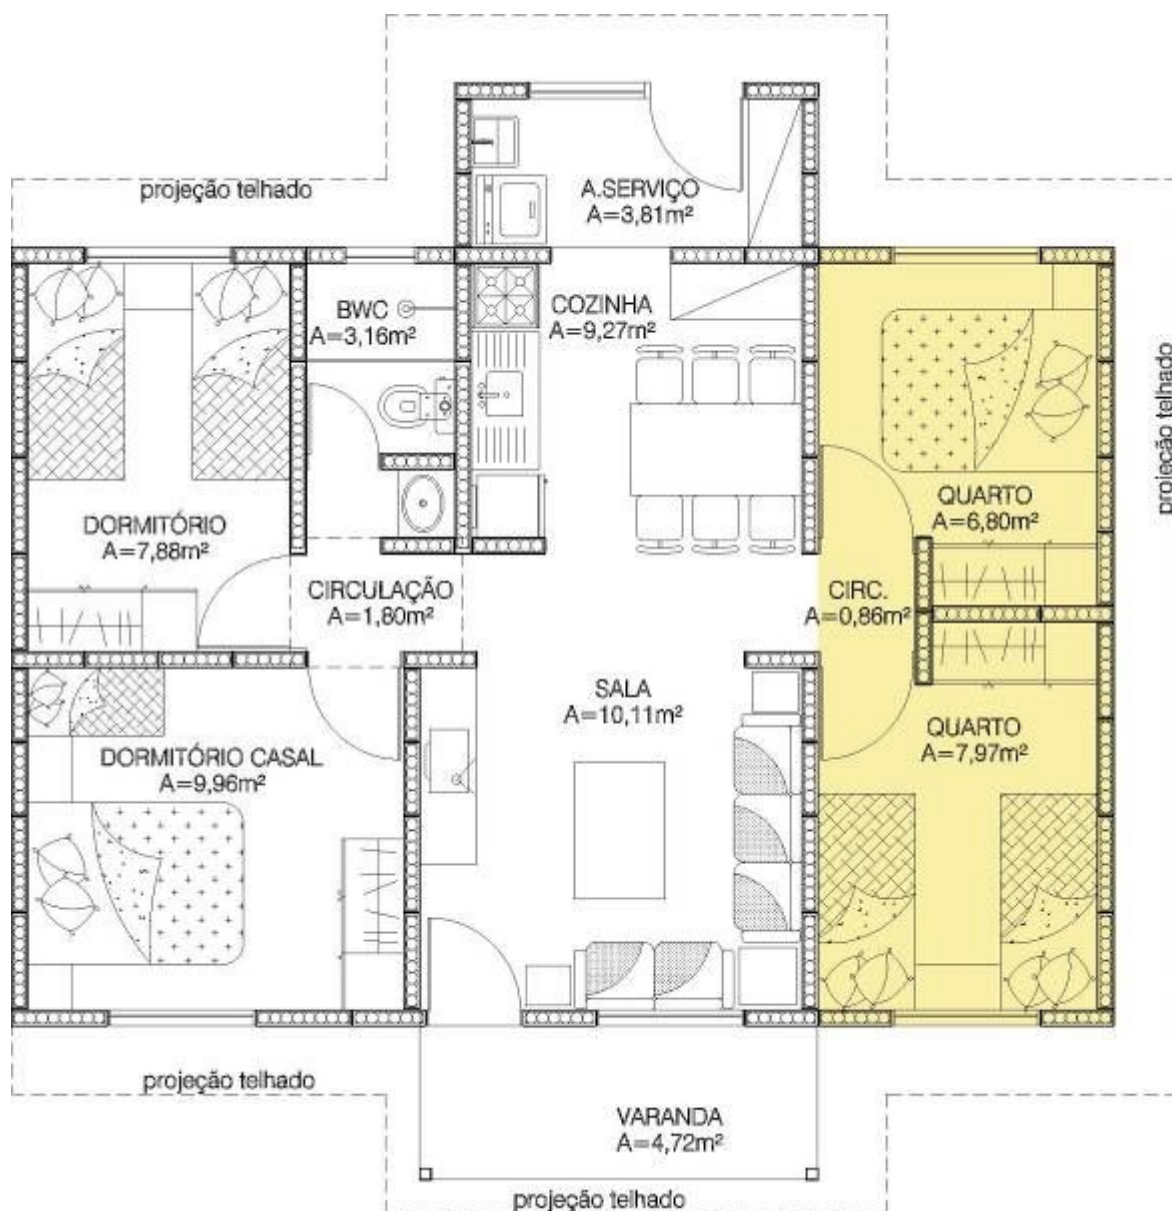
Planta baixa da casa com opção de ampliação de dois dormitórios adicionais.
